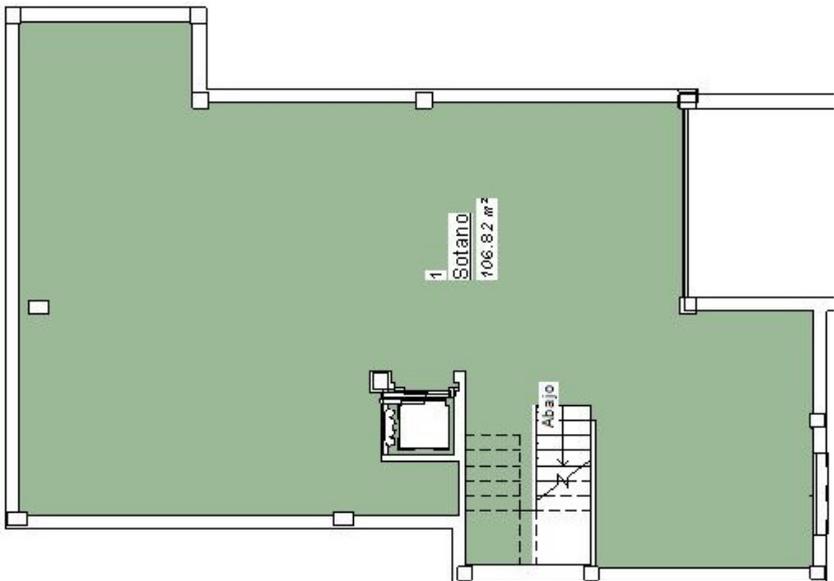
Plano de Planta Sótano. Fuente propia Revit
